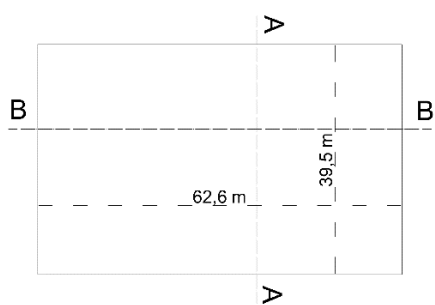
Planta simplificada da escavação para o modelo 2D.
